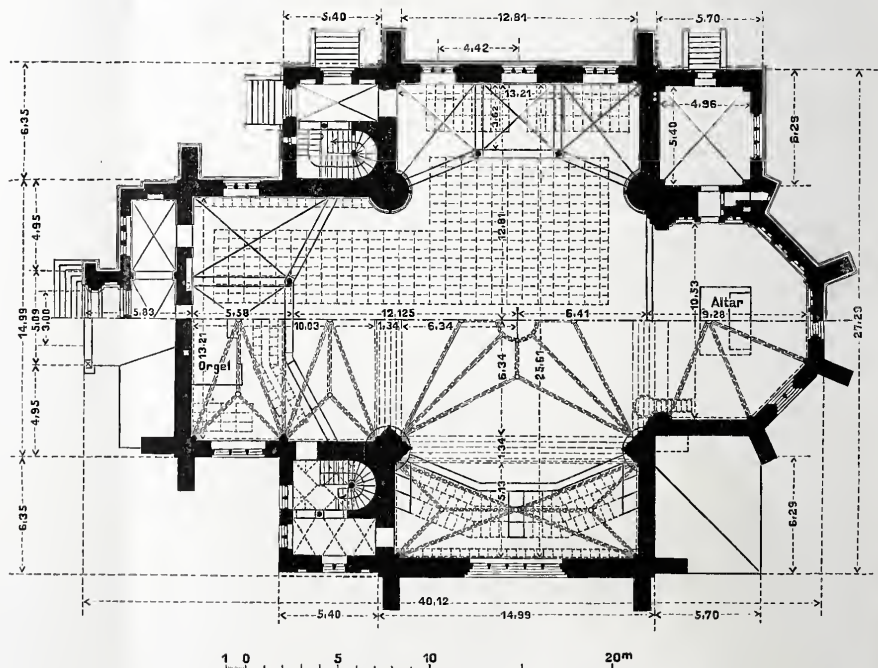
Grundriß zu ebener Erde und in Emporenhöhe.
